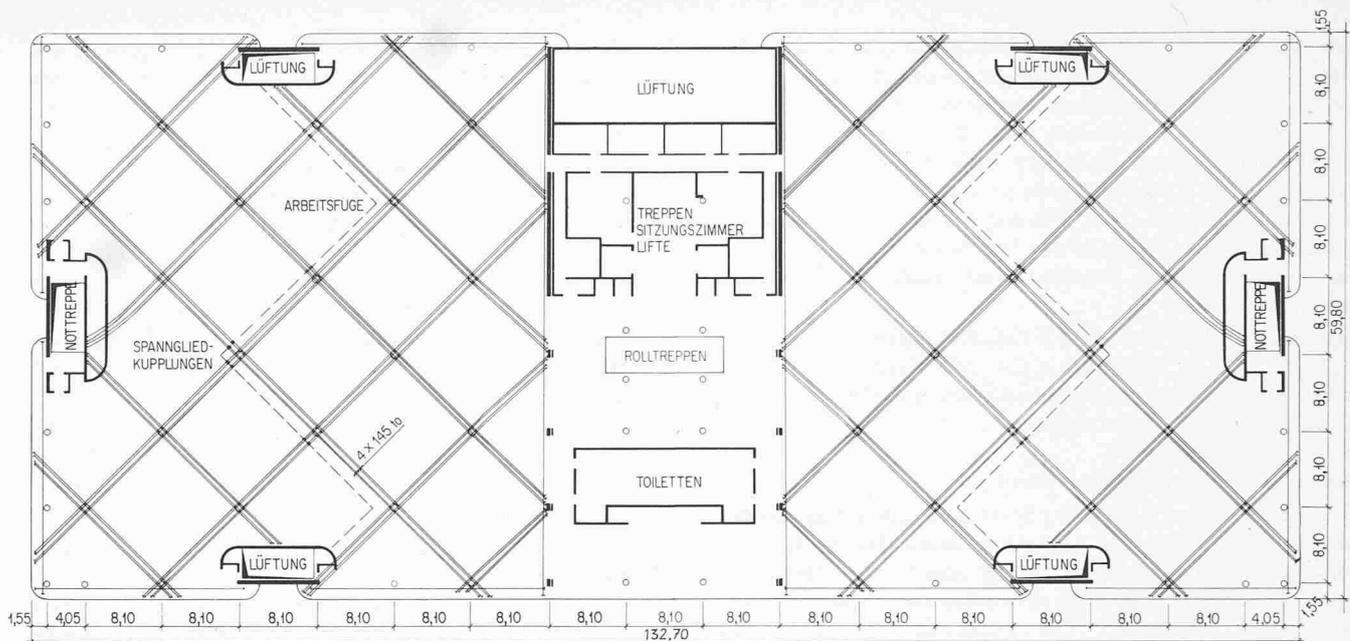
Grundriss eines Bürogeschosses im Verwaltungsgebäude der Hoffmann-La Roche & Co. AG, Basel. Flachdecke mit Gurtstreifenvorspannung
